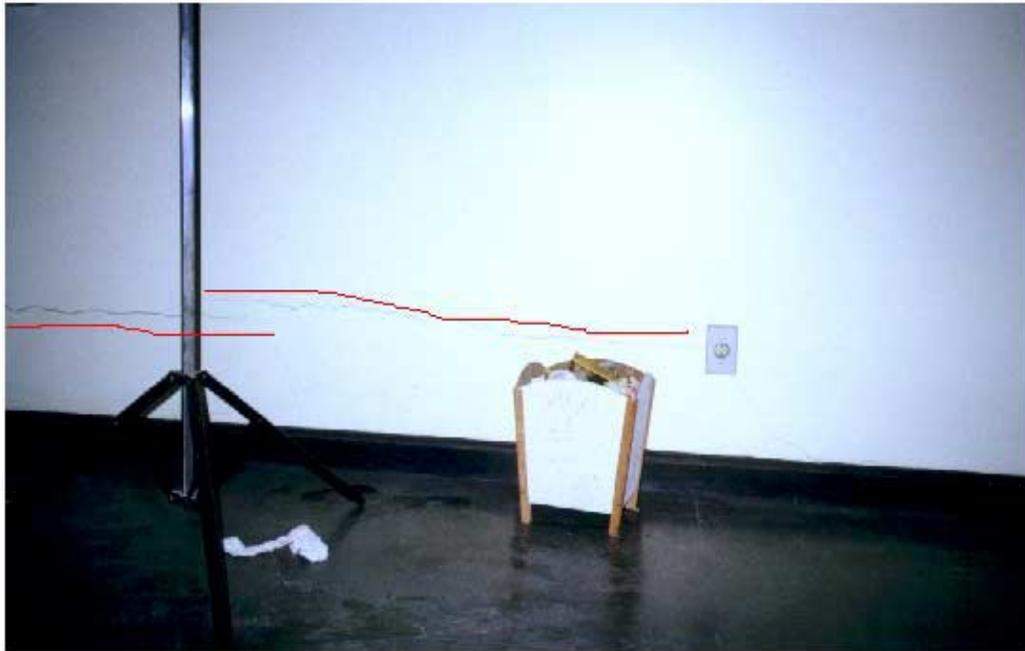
Fissura horizontal causada por torção da laje de apoio em edifício com estrutura metálica
